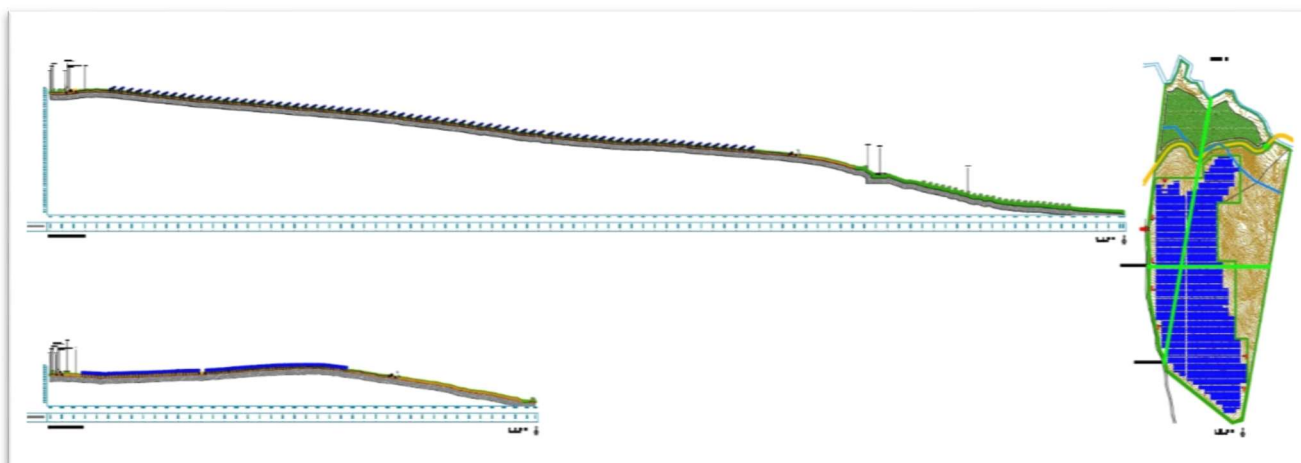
Area 2 Profili longitudinale e trasversale di progetto
